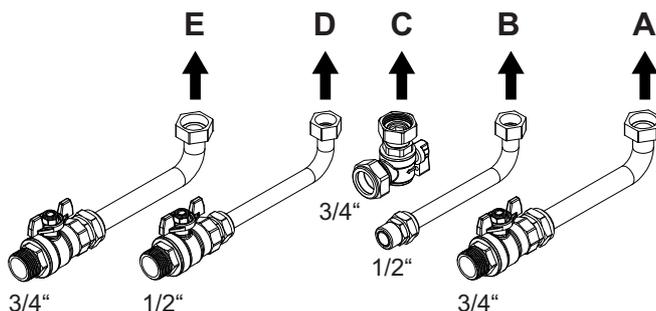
Set di collegamento idraulico GWHYA1 per raccordi a parete standard (raccordi A - E v. figura 4-2)
